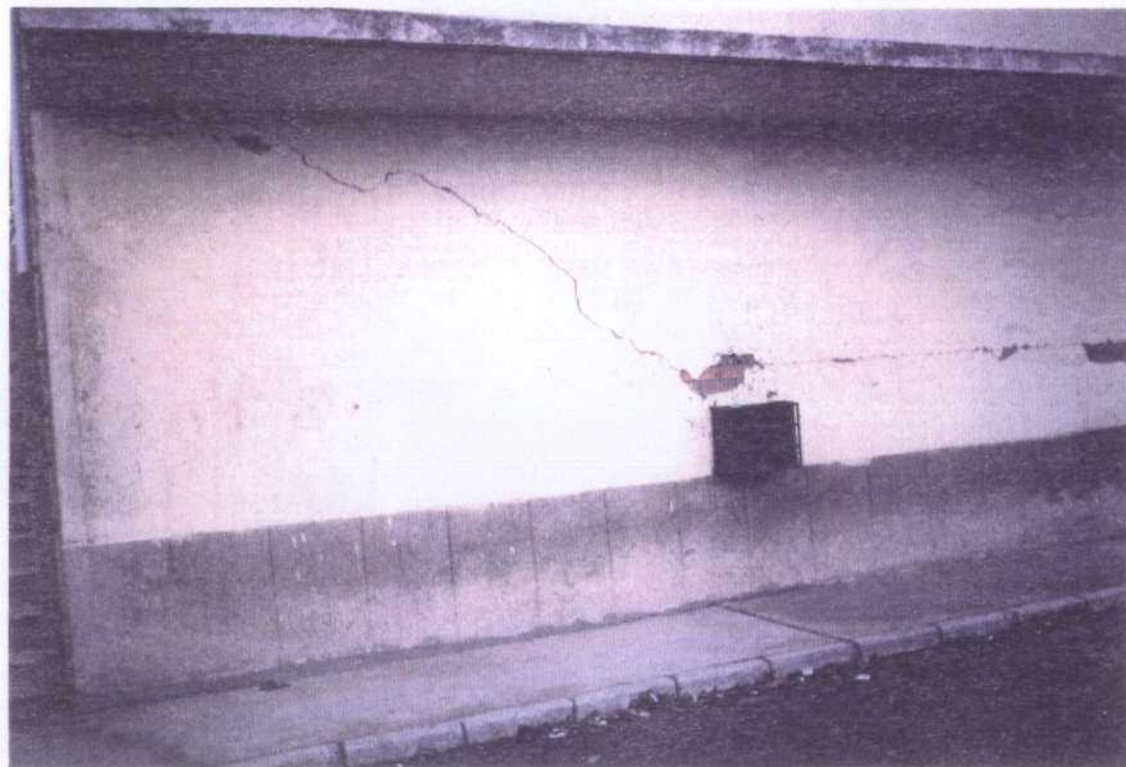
Unica grieta observada en la fachada del I.F.P. de Fabero.
